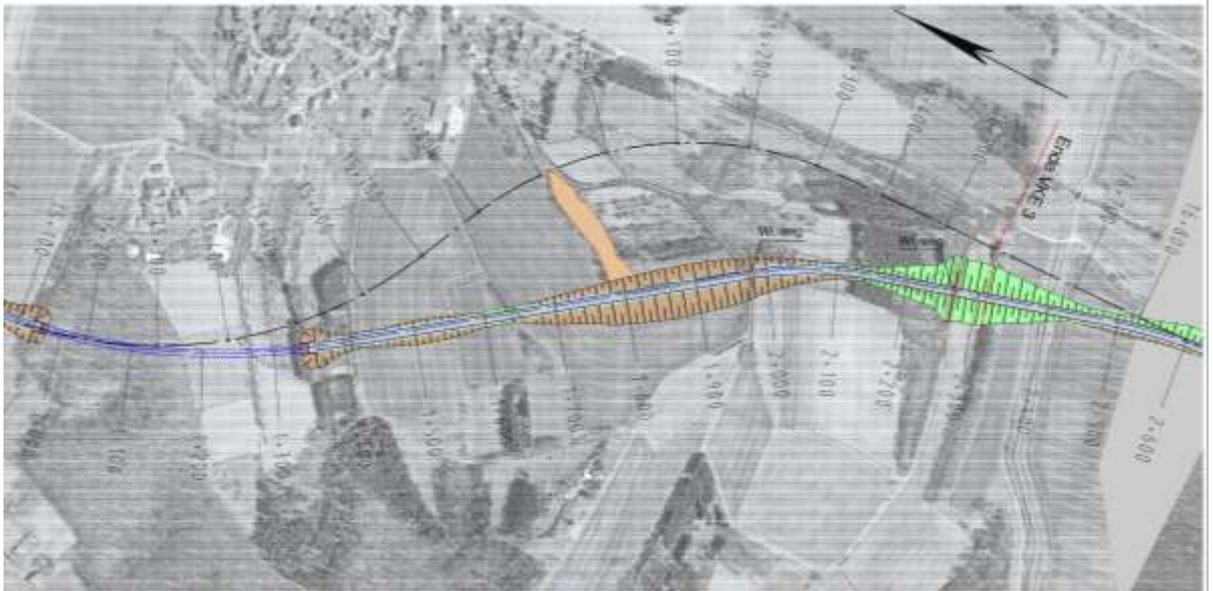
Lageplan Variante Ortsrat Gerblingerode
